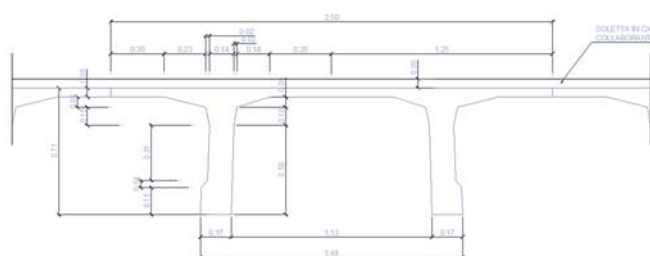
SEZIONE TIPO SOLAIO DI COPERTURA
